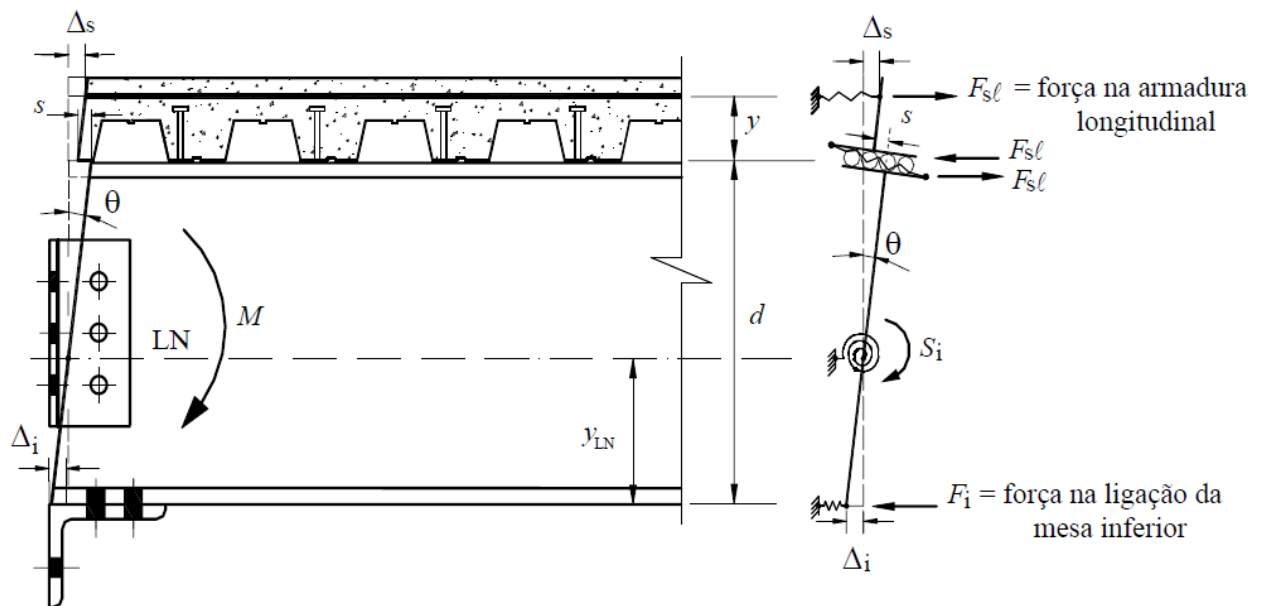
Modelo para a rigidez do conjunto da ligação mista [NBR 8800]
